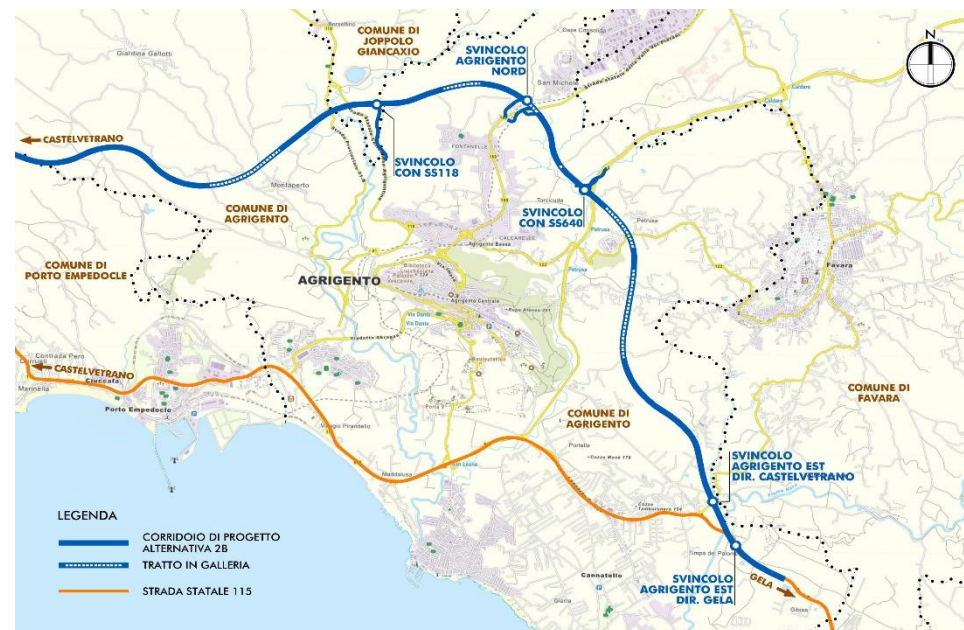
Alternativa 2B: planimetria di progetto tratto est
